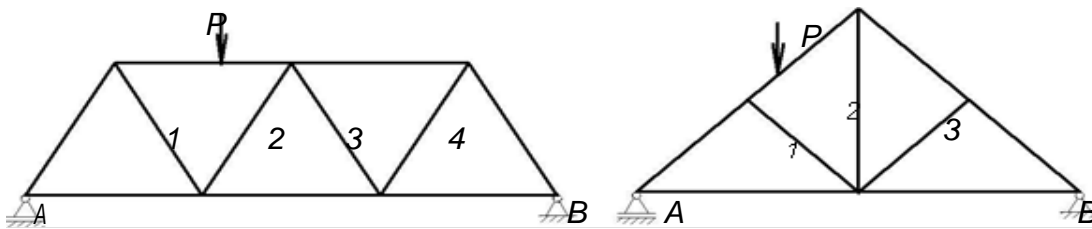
Расчетные схемы металлической и деревянной ферм
